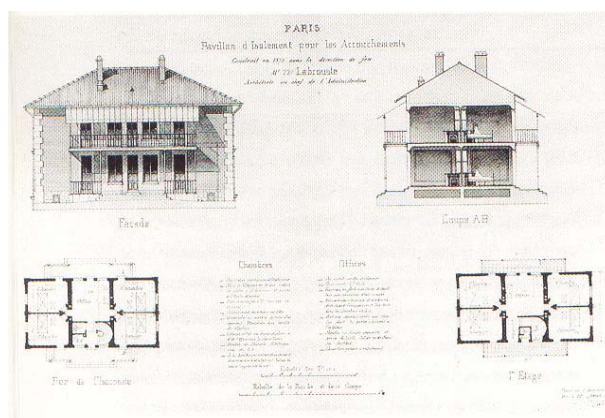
Fachada, corte e planta baixa do Pavilhão de Isolamento da Maternidade de Paris, 1875. Fonte: Musée de L'Assistance Publique, 1995.
